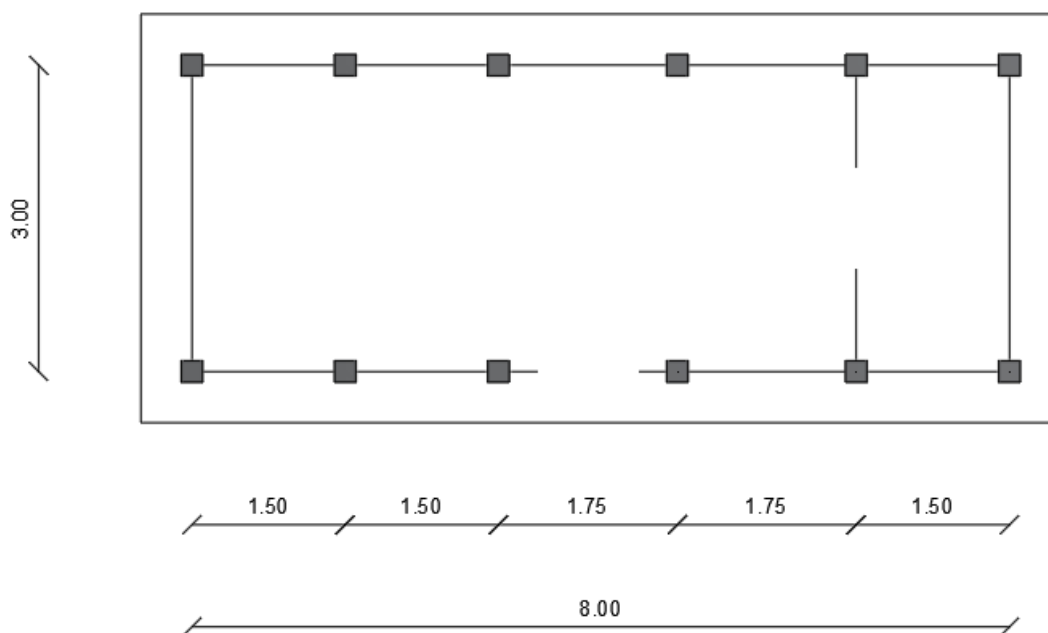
Pianta dell'edificio a seguito delle modifiche.
